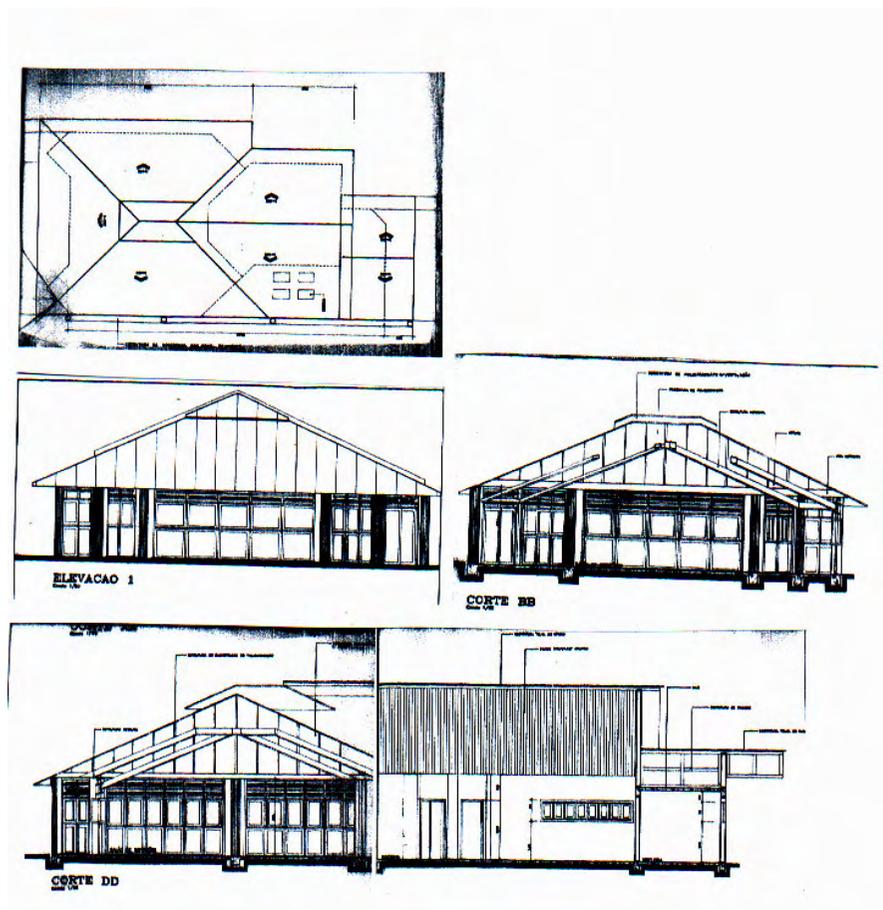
Planta de cobertura, elevação e corte transversal e longitudinal do Buffet anexo do restaurante. Fonte: Arquivo do Hotel Hidrotermal.
